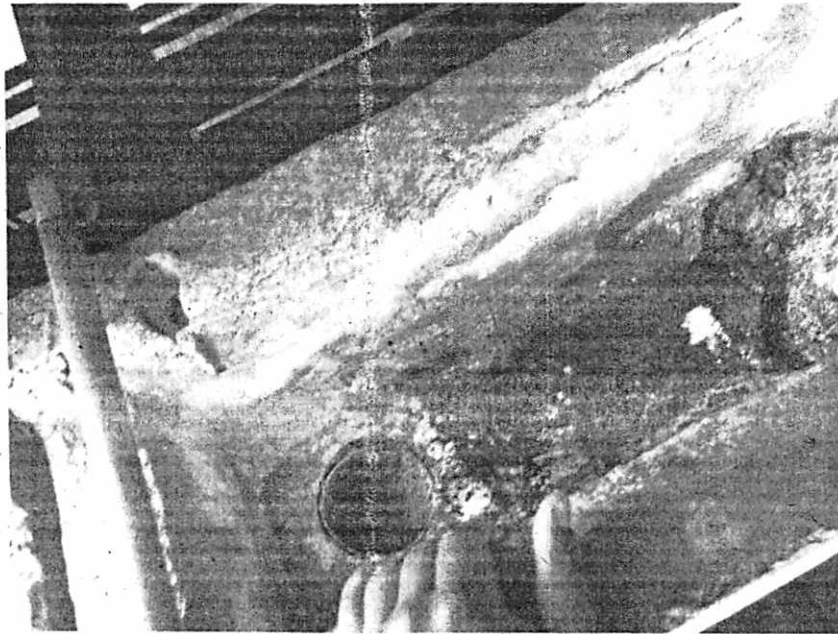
Vista do ralo, tubo de descida das águas pluviais na parte interna da viga calha.
